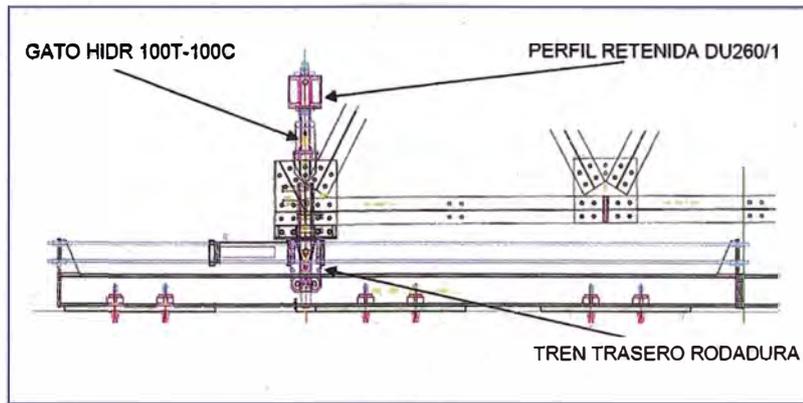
Vista Alzado del Apoyo Trasero - Fuente: Elaboración Propia
